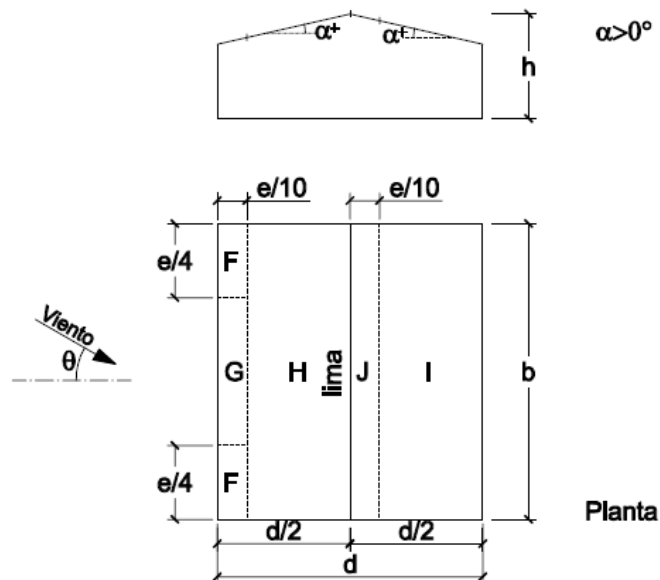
Zonas de la cubierta de tenis para viento transversal.
